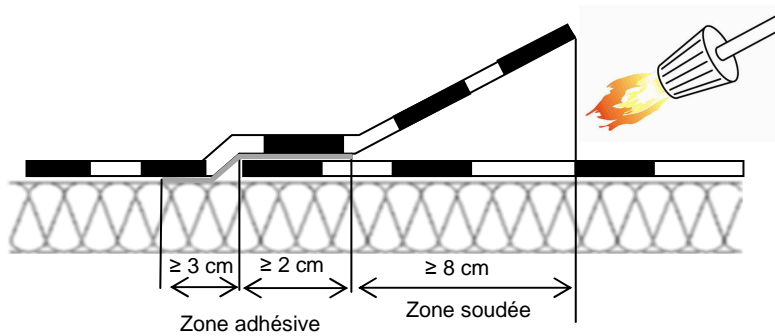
Soudure du joint longitudinal sur FORCE 4000 ADH
